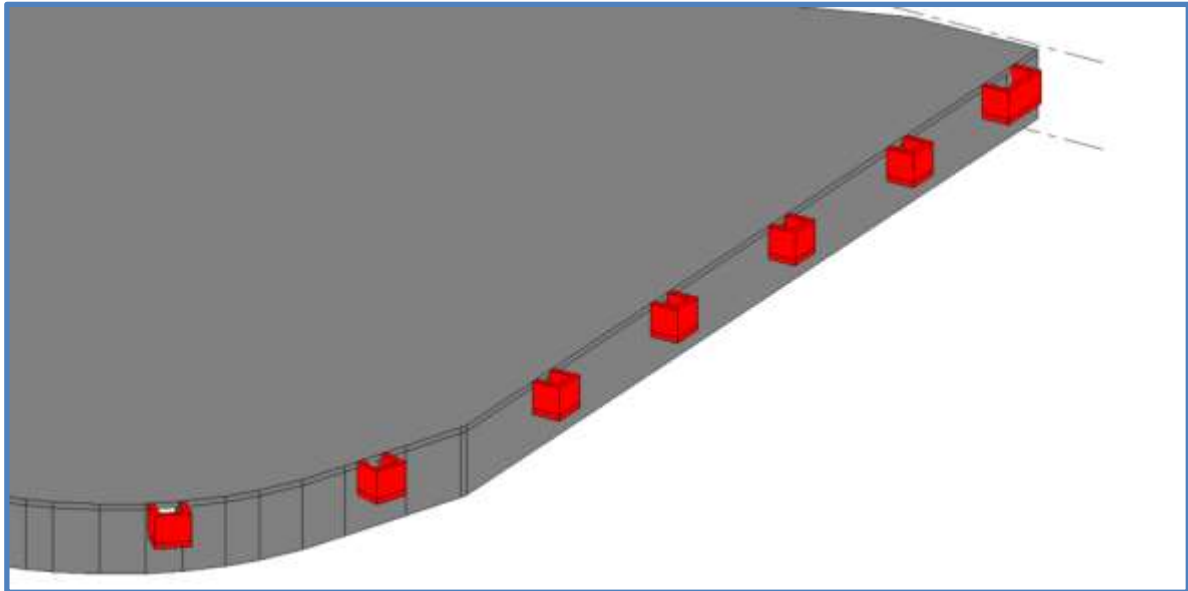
Novos poços ingleses a considerar para admissão de ar às grelhas de ventilação na parede norte
